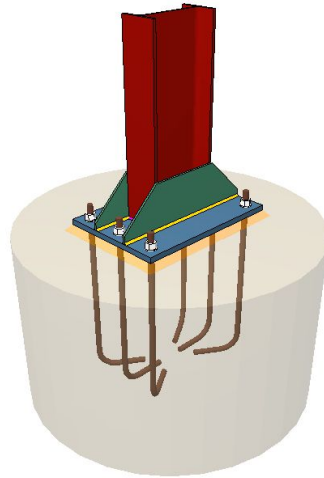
Anclaje de los pilares centrales correspondientes a los pórticos de fachada
